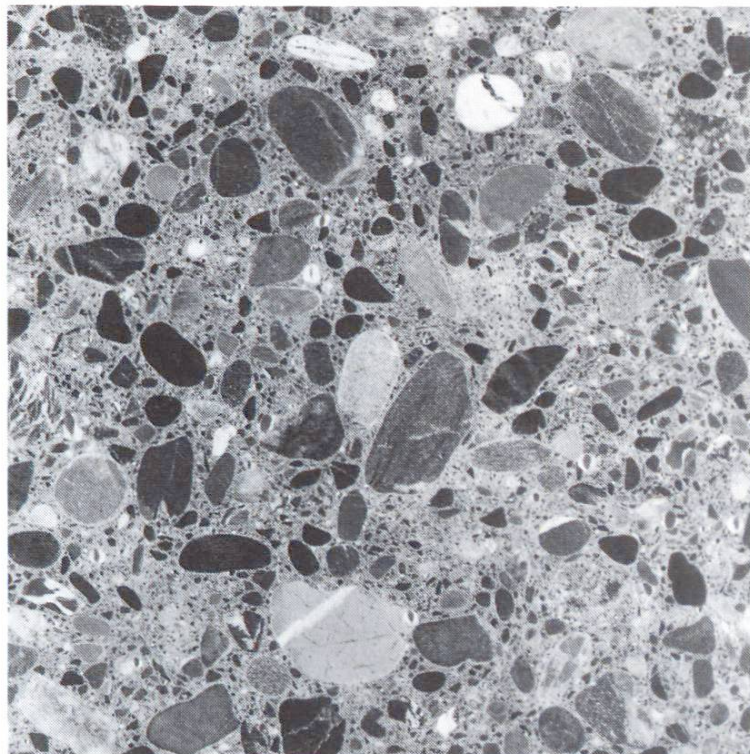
b Betonstruktur zur Siebkurve B (Sägeschnitt)
